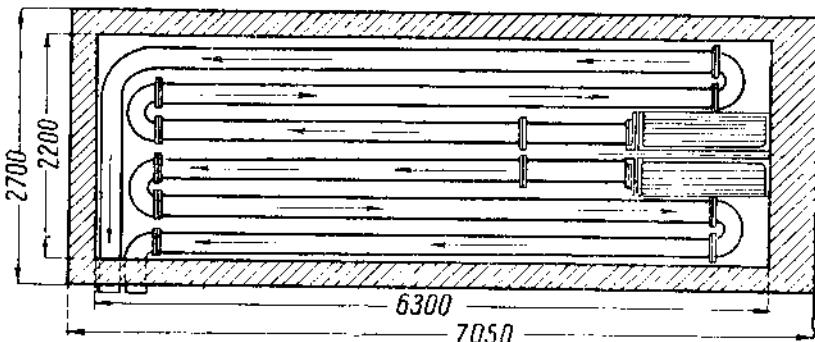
План расположения калориферных труб сушилки „Бессарабка“.
